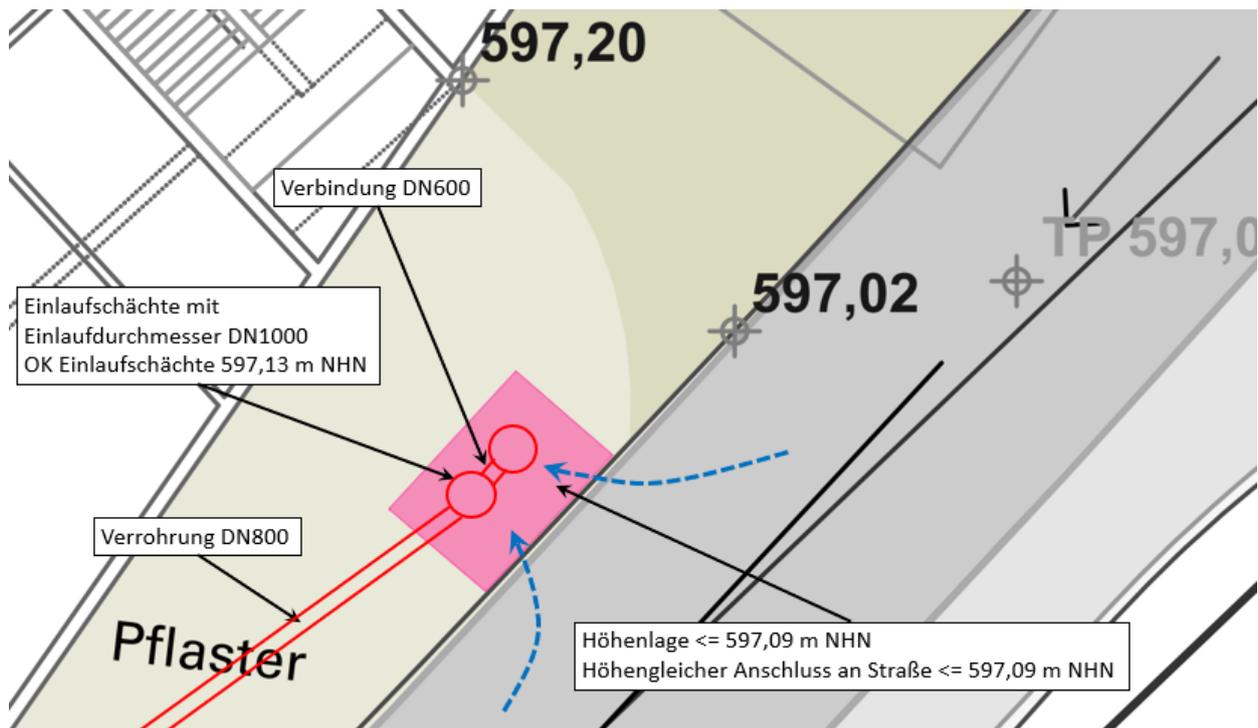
Angepasster Planungszustand, Detail Einlaufbereich (Plangrundlage: Ingenieurbüro mahl gebhard konzepte, München)
